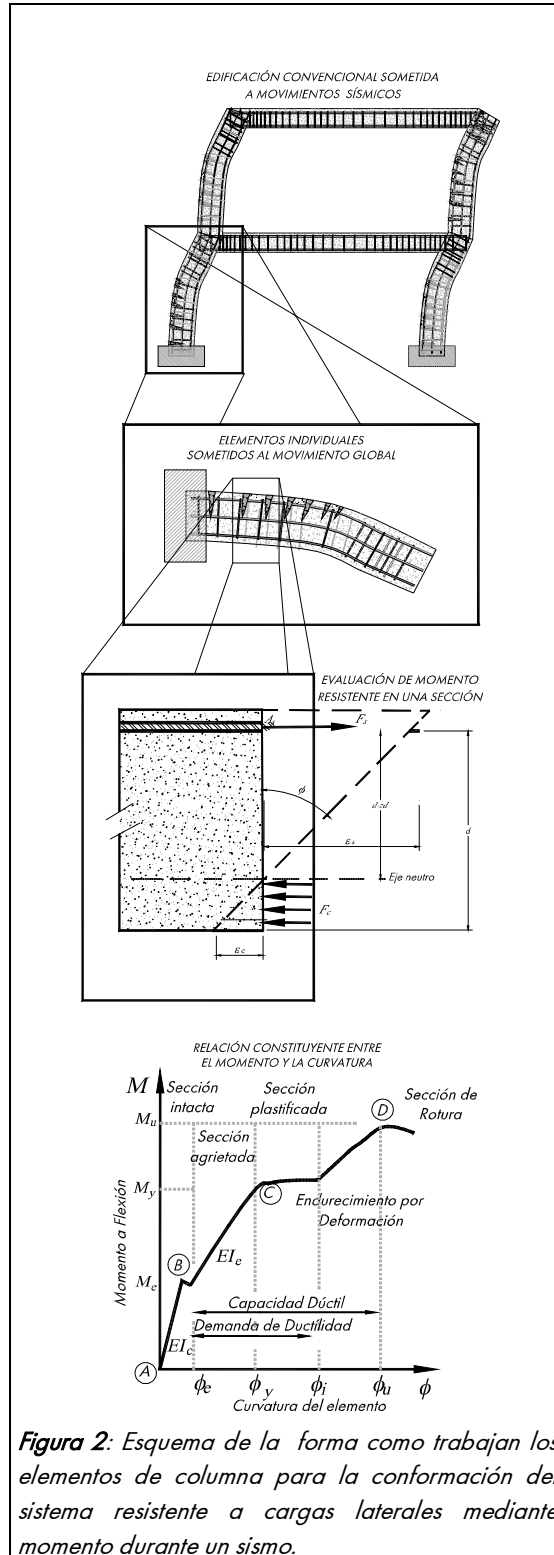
Esquema de la forma como trabajan los elementos de columna para la conformación del sistema resistente a cargas laterales mediante momento durante un sismo.
